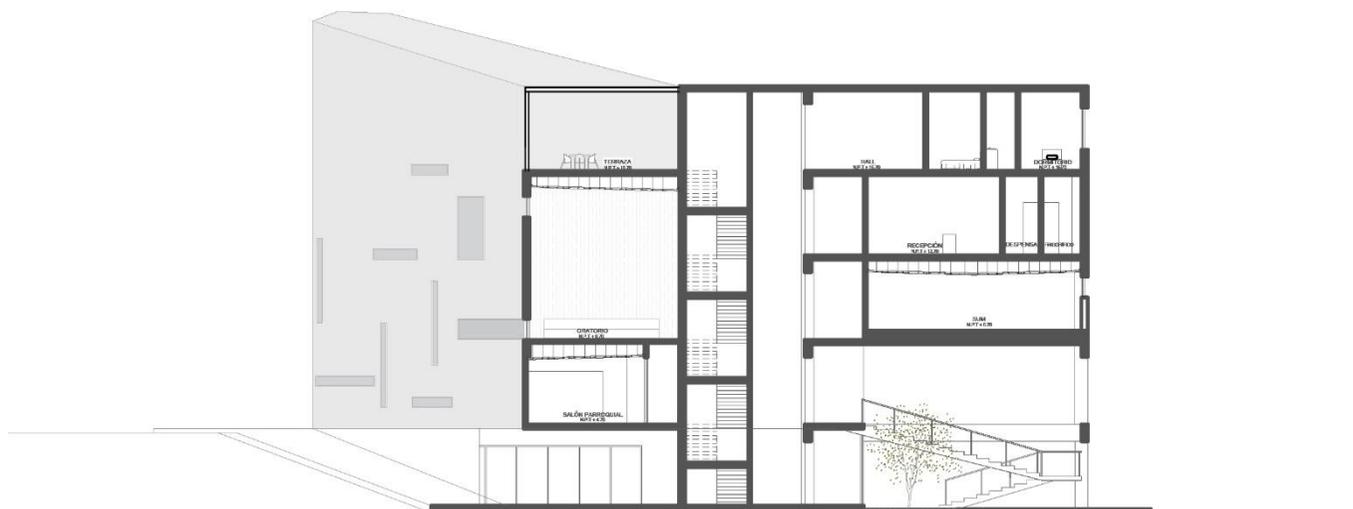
Corte longitudinal 4. Fuente: Propia.
